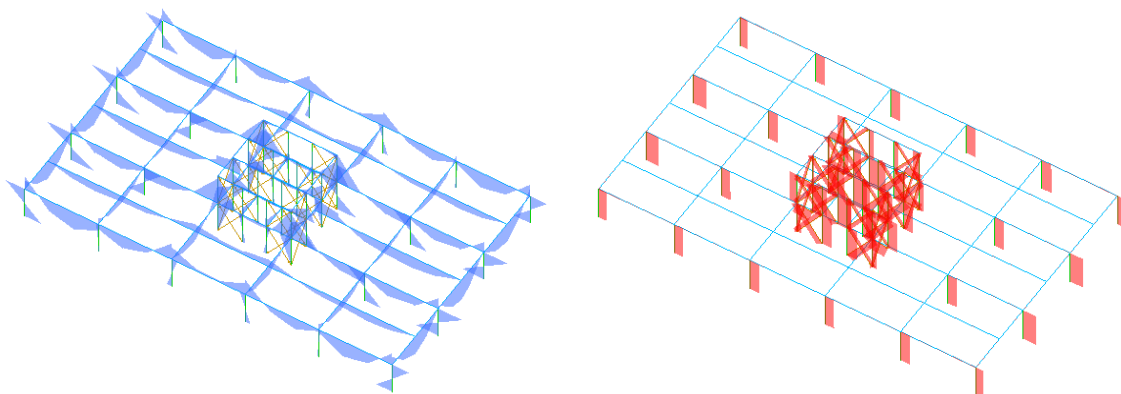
Diagramas de momentos flectores en vigas y esfuerzos axiales en pilares en planta de cubiertas
